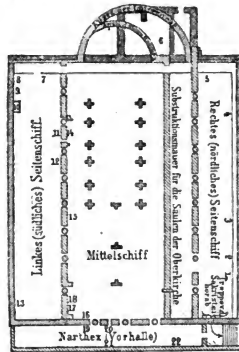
Grundriss von S. Clemente (Unterkirche).
